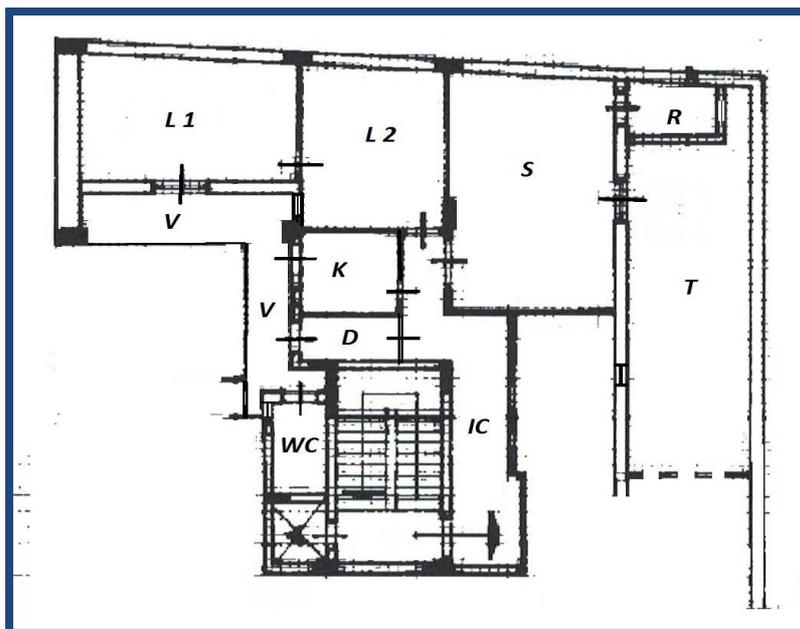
Rappresentazione planimetrica dell'appartamento (disegno non in scala)
